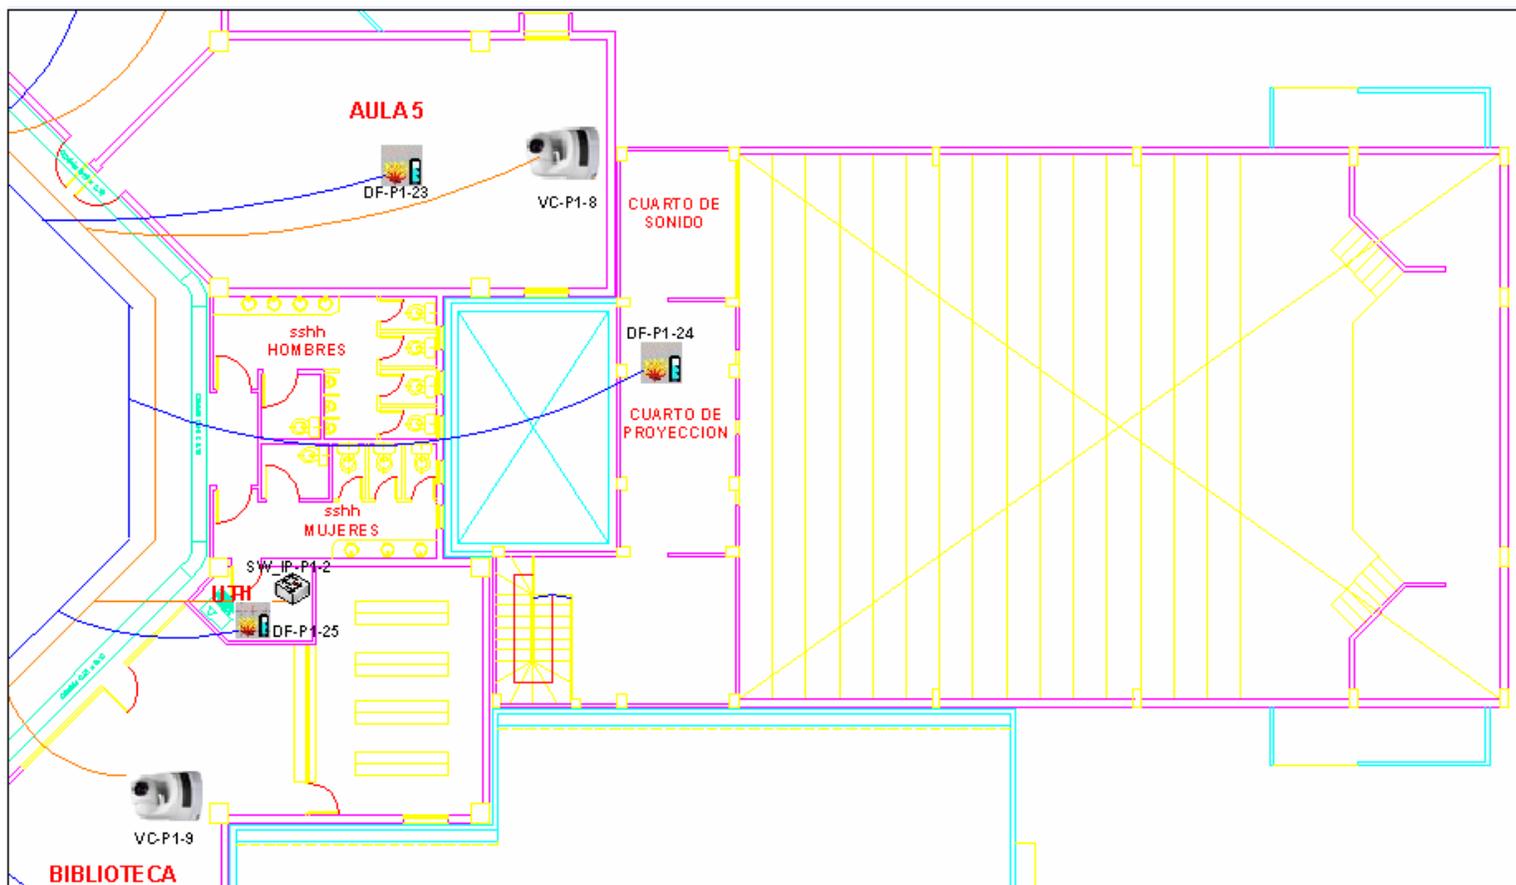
PLANO SEGURIDAD PRIMER PISO SECCION 3
